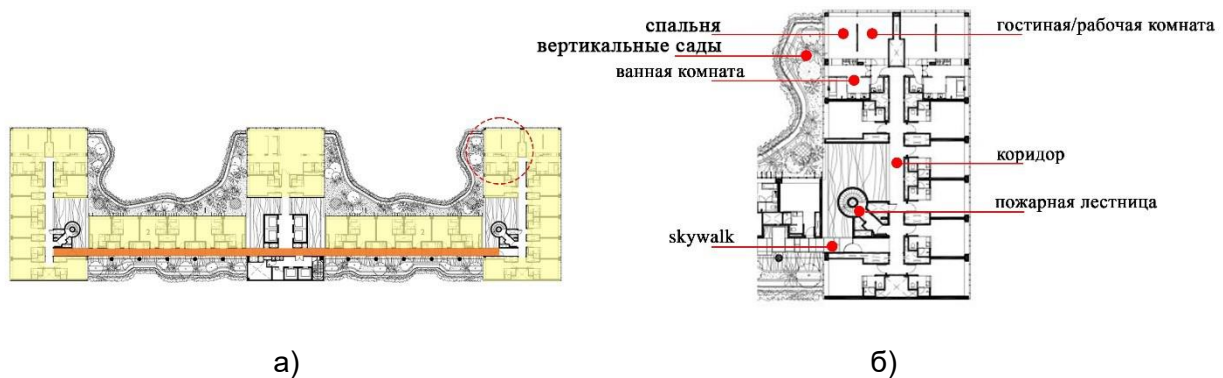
План уровня жилых номеров гостиницы: а) план типового этажа с указанием номеров; б) решение планировки жилого номера
